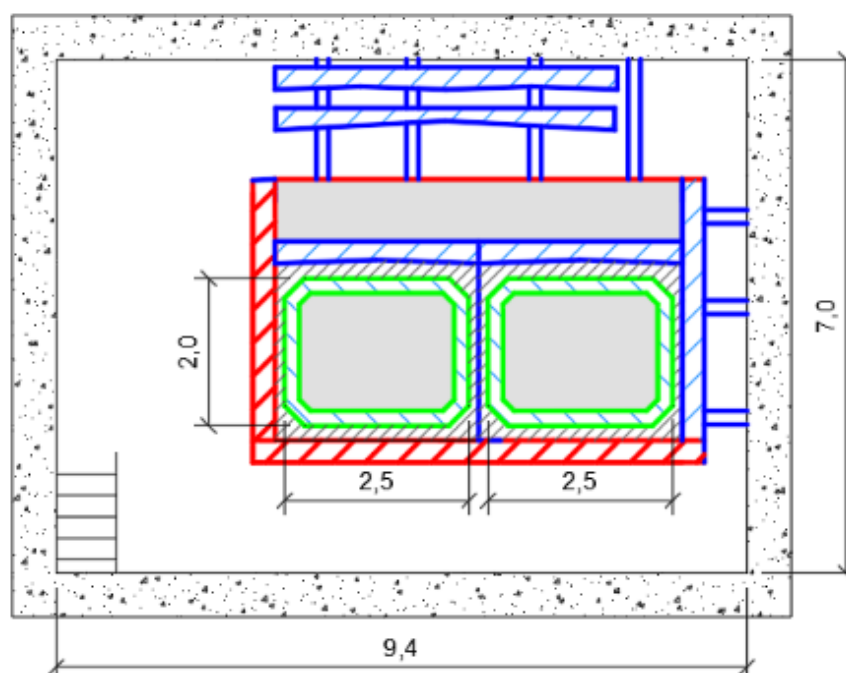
План предлагаемой пропарочной камеры в момент изготовления двух железобетонных прямоугольных звеньев водопропускной трубы прямоугольного сечением 2,5x2,0м на Стенде.
